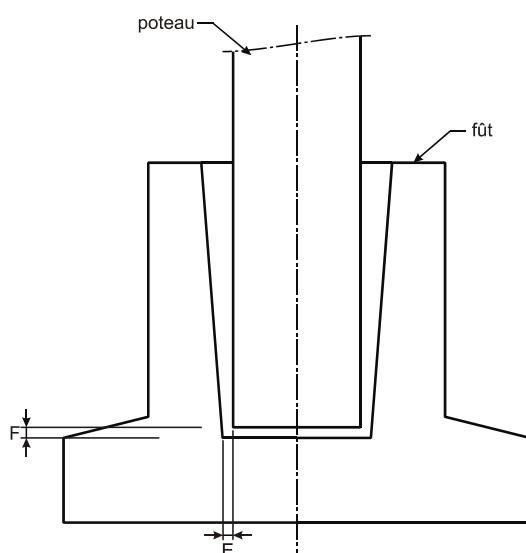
Assemblage poteau-fondation par plot à encuvement
